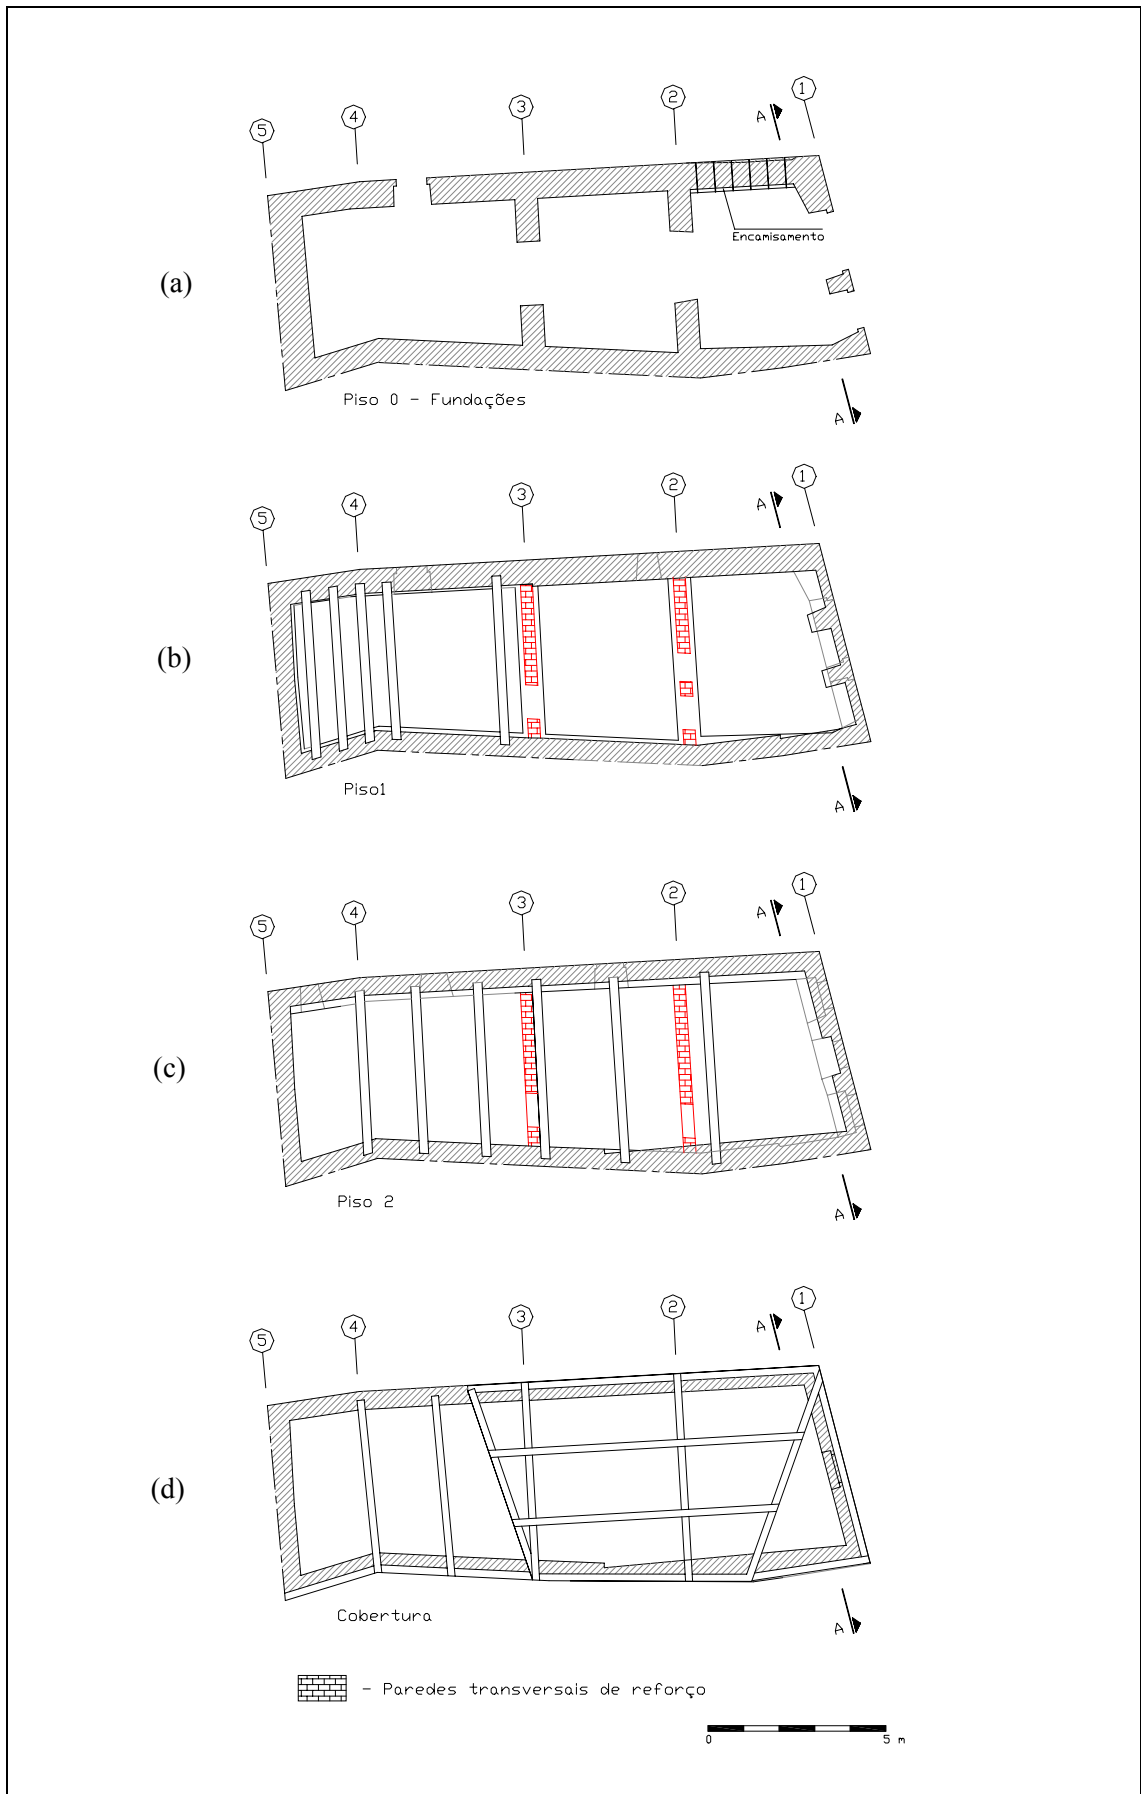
Plantas estruturais. Paredes, pavimentos e cobertura.
